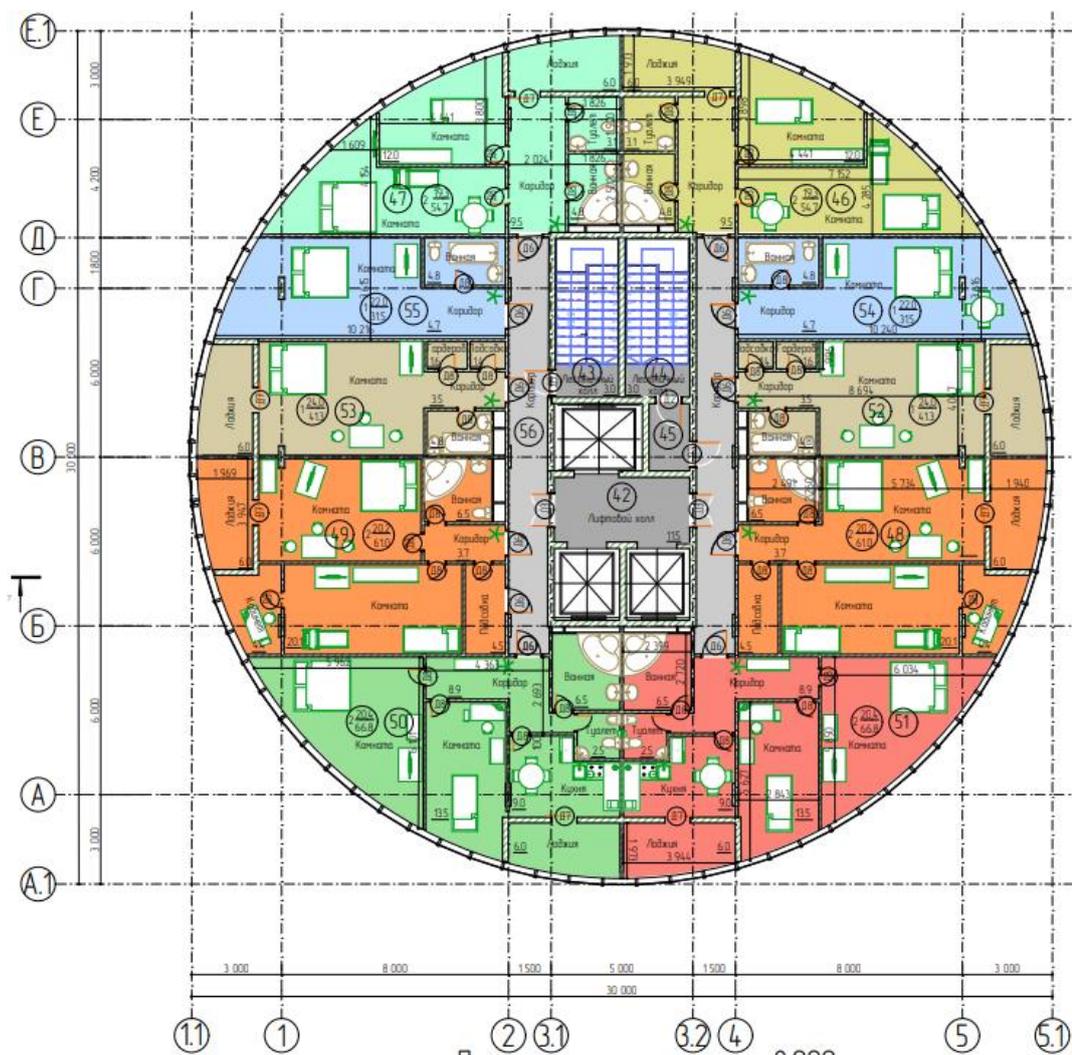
План типовых этажей с 13 по 21 этаж
